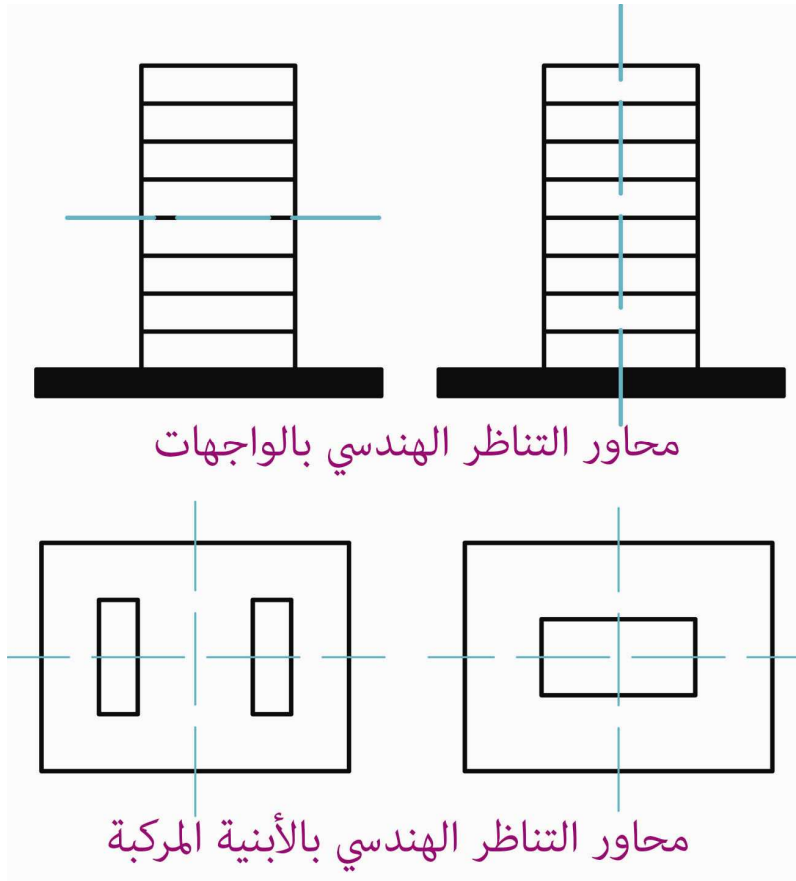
محاور التناظر في التشكيل الهندسي الأفقي (الباحث)
